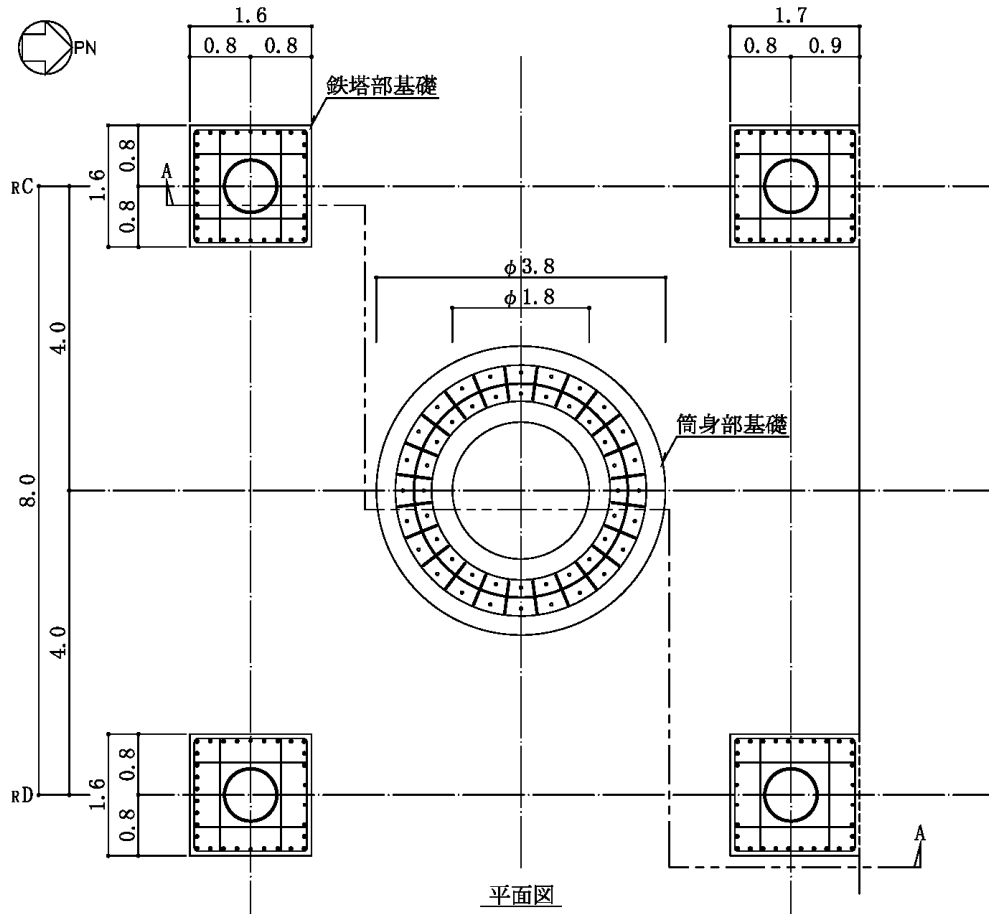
主排気筒の基礎の概要図 (単位 : m)
